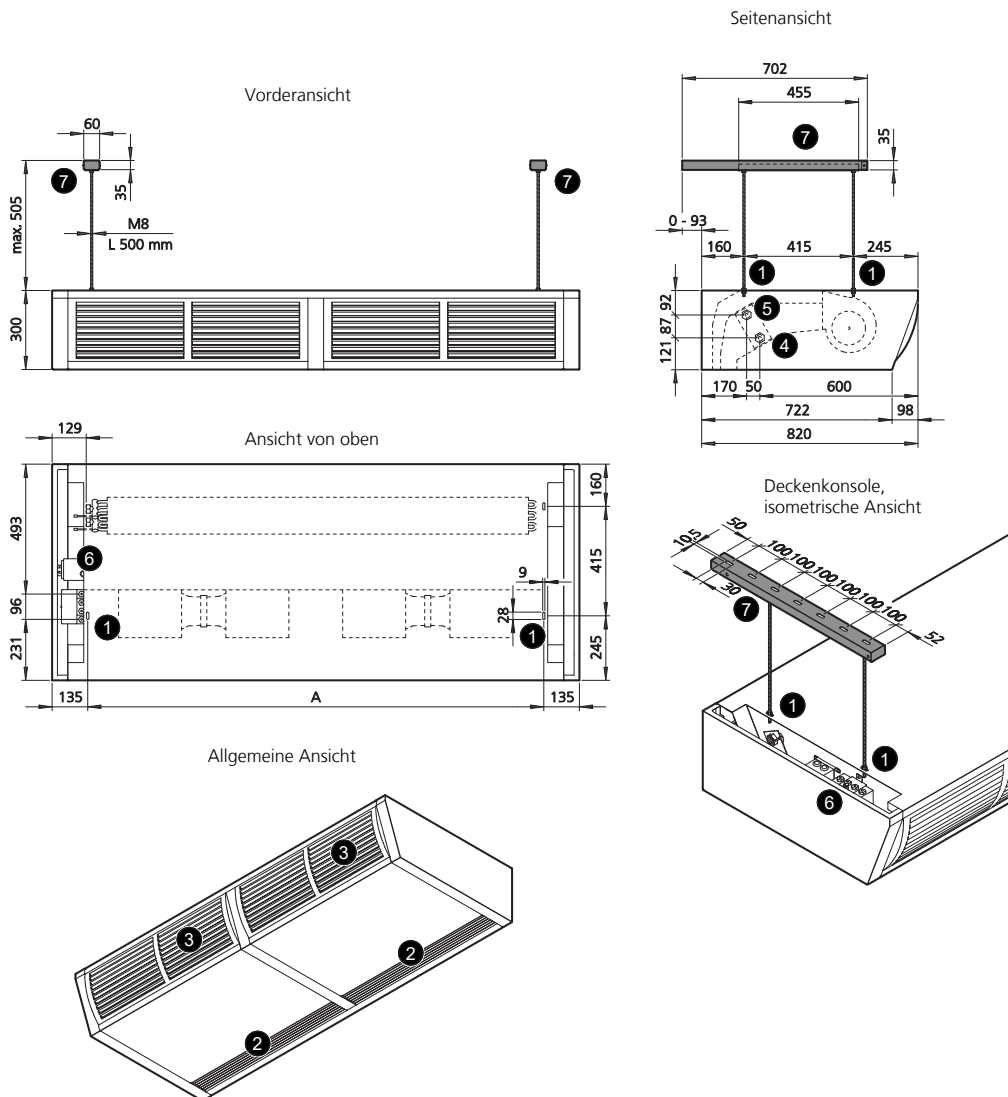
Aufhängepunkte Tandem 300 BG 12 - 30 mit Deckenkonsolen
